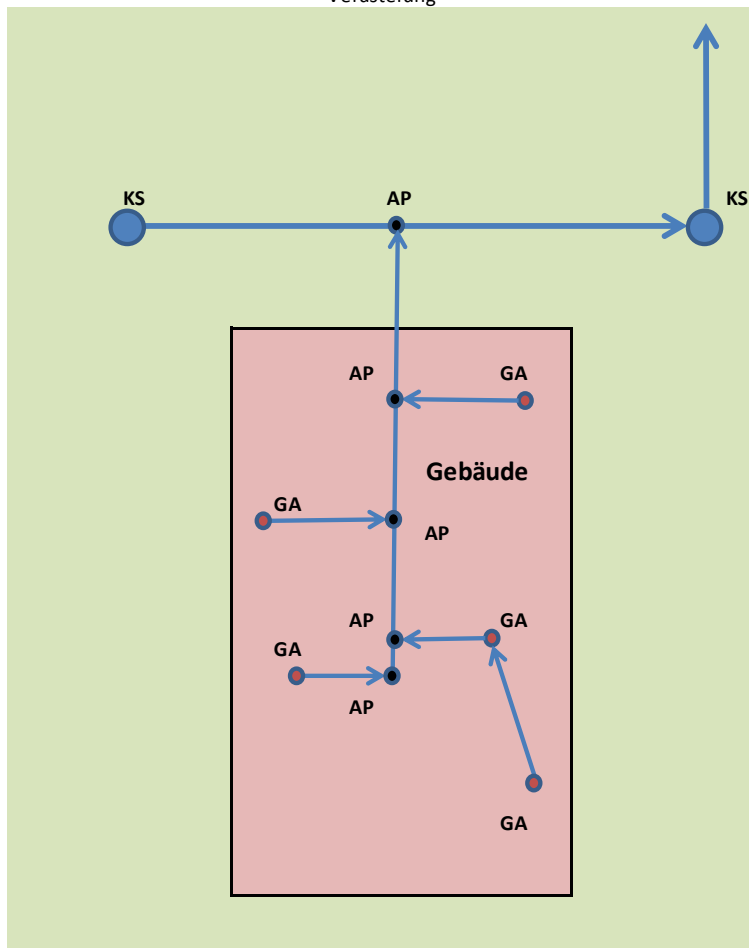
Nicht fachgerechte Grundleitungsführung
